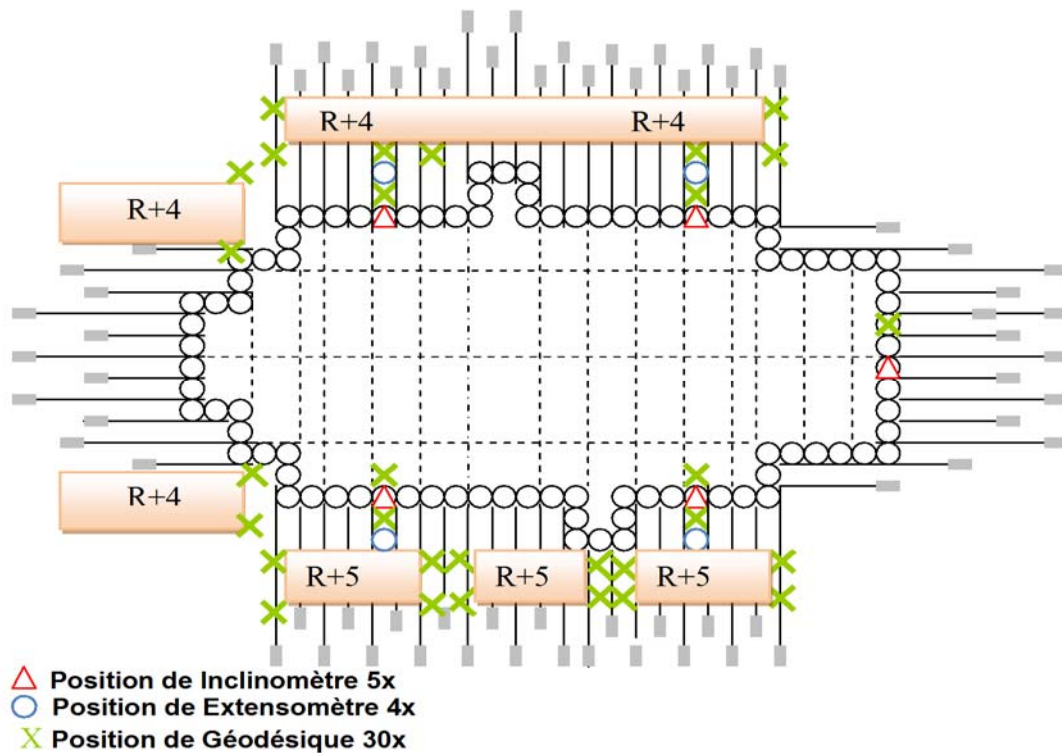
Vue en plan de la station d'Ain Naadja (02)
